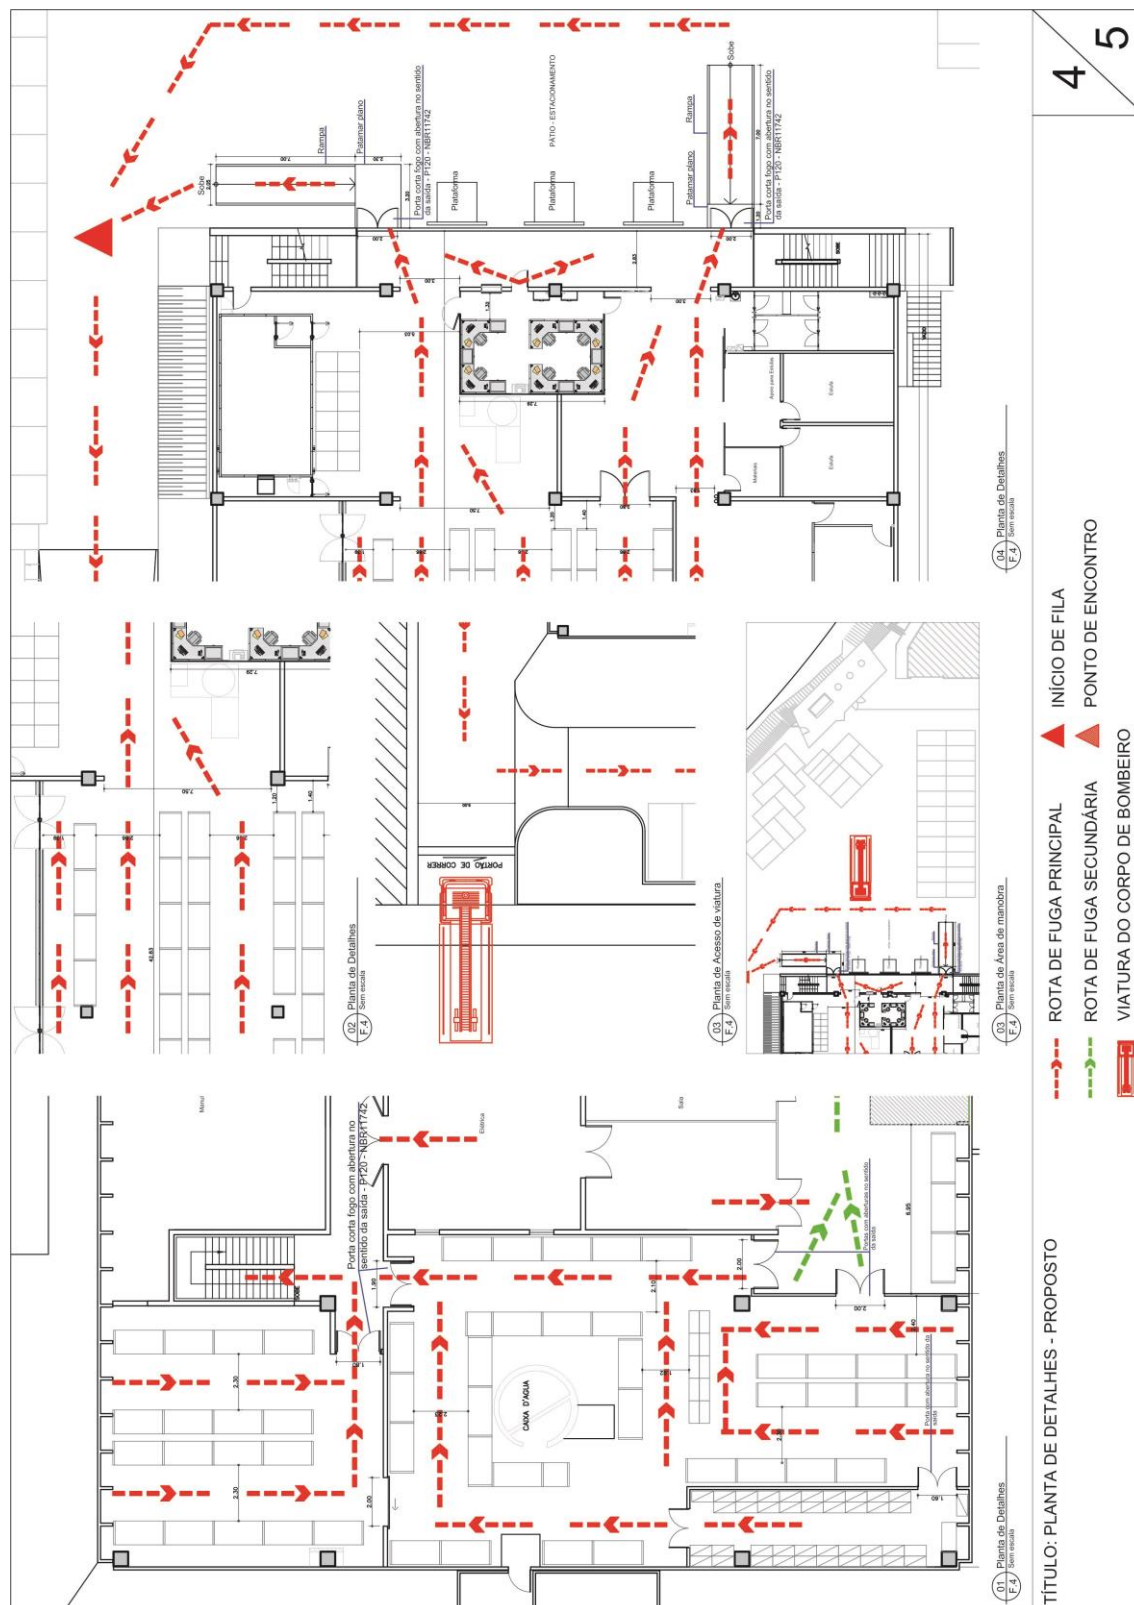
Planta de detalhes - proposta, São Paulo - SP
